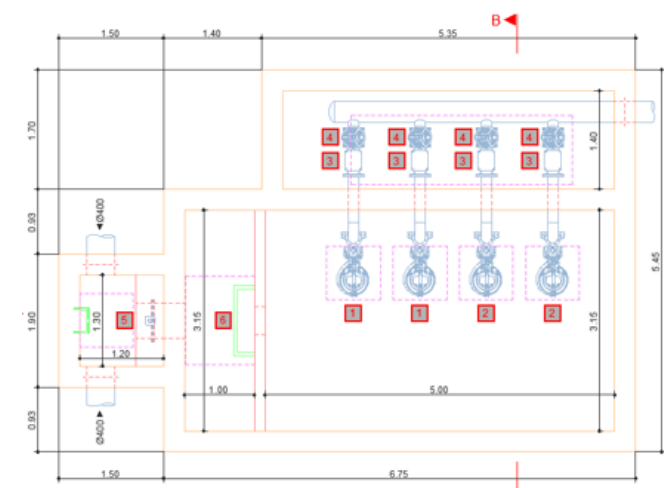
EBAR Praza do Regueiro. Planta equipos-geometría
